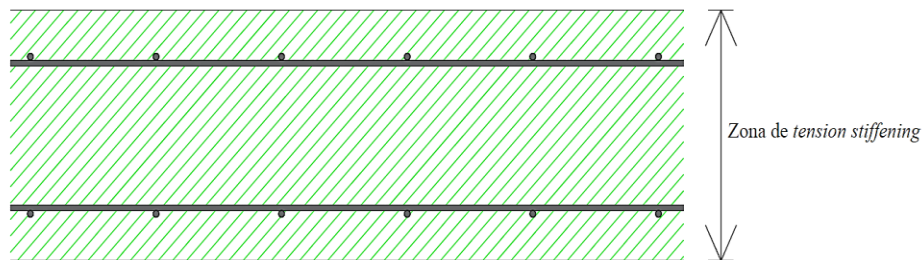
Identificação da zona de *tension stiffening* numa laje de betão armado de espessura reduzida.
